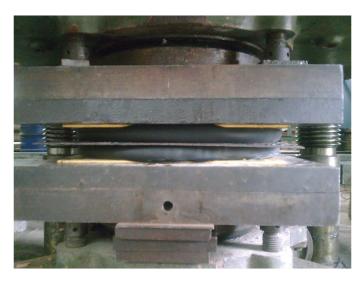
Испытания РСБ на сжатие на специальном стенде
